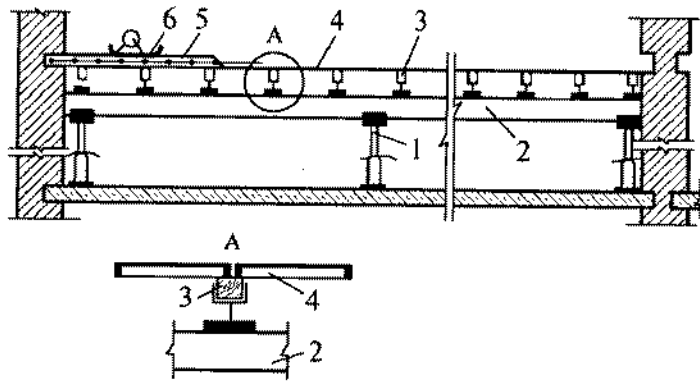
Схема устройства монолитных безбалочных перекрытий:
